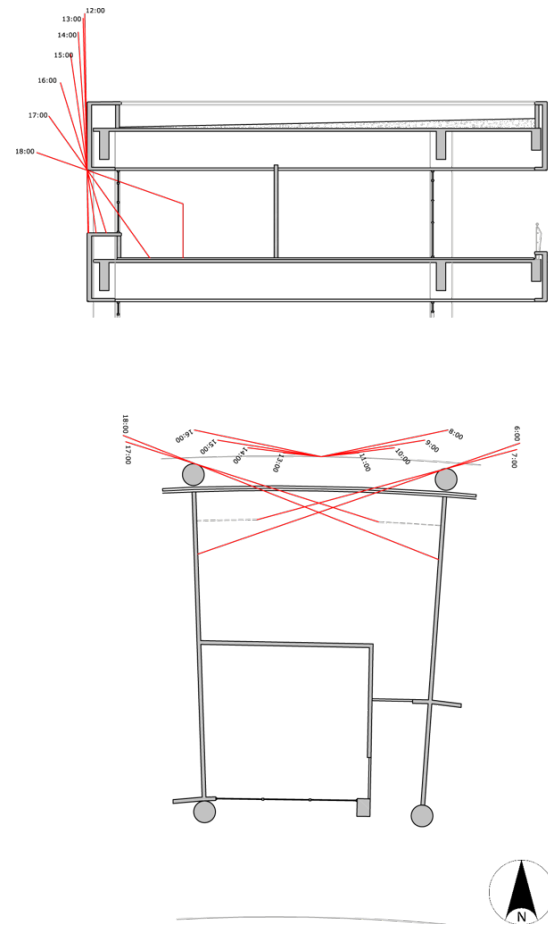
Corte y planta del aula F-303 y F-302 (orientación sur y norte respectivamente) con la incidencia solar por hora en mayo.
